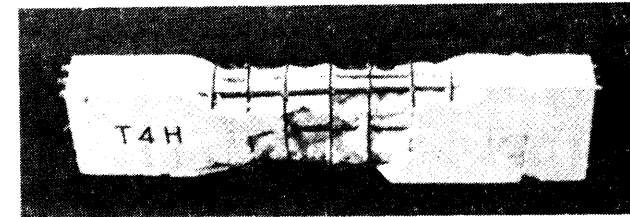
balok beton bertulang yang mengalami keruntuhan akibat torsi murni. (Tes Rutgers: Law, Navy, dkk.)
